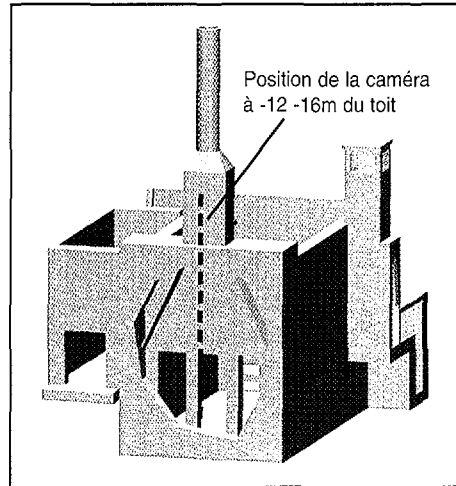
Inspection partielle de la casemate par le conduit de sortie de la ventilation naturelle
